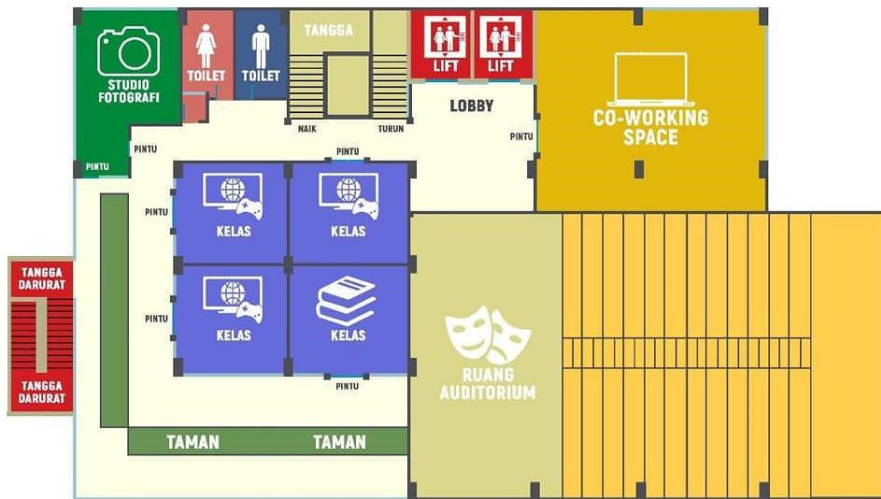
Denah Lantai 1 Bandung Creative Hub
